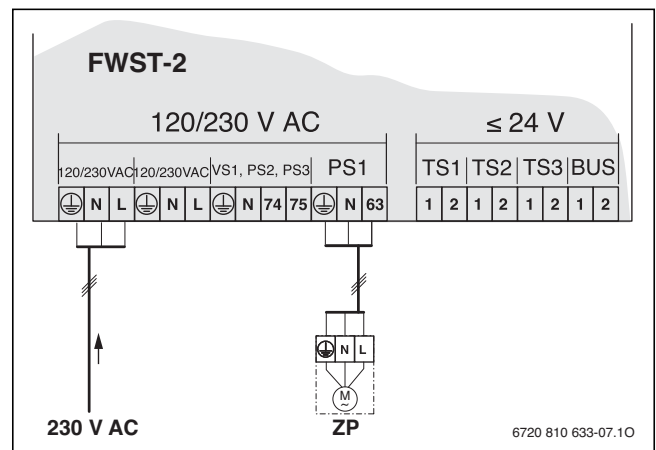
Anschlussplan CU FWST-2 (Legende -> Bild 1)
